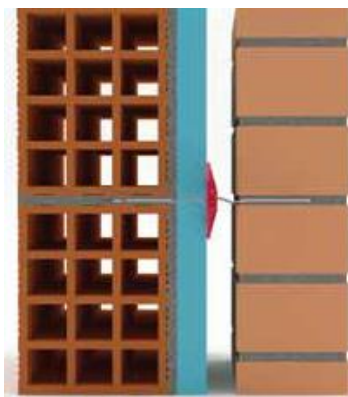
Corte de pano tijolo face à vista com grampo metálico com pingadeira [17]
